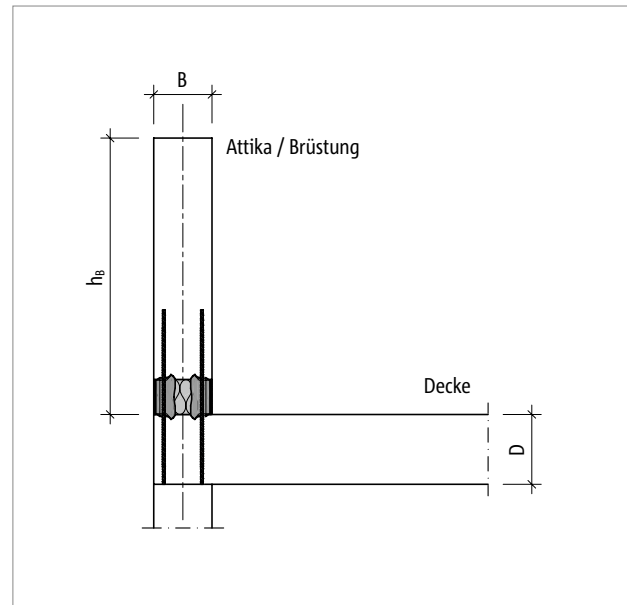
Schöck Isokorb® CXT Typ AP: Statisches System
